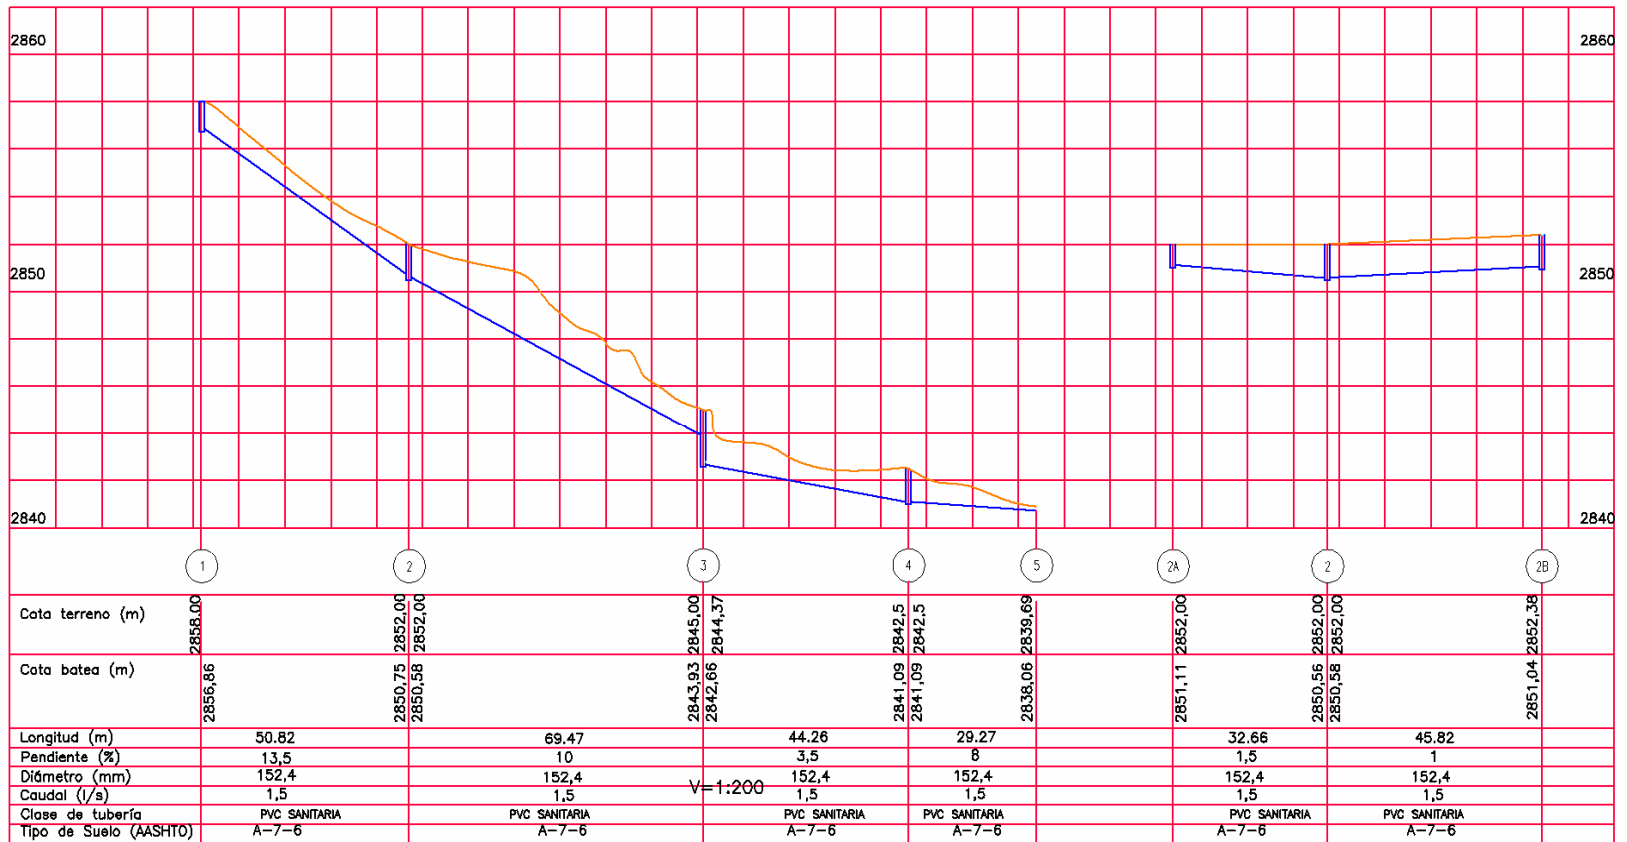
Perfiles alcantarillado sanitario.(Anexo plano N° 3)
